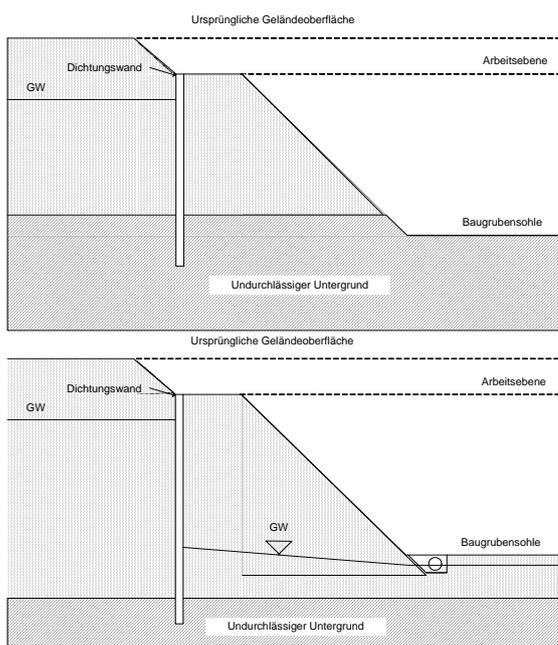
Grundwasserabsperung oberhalb einer undurchlässigen Schicht [1]
